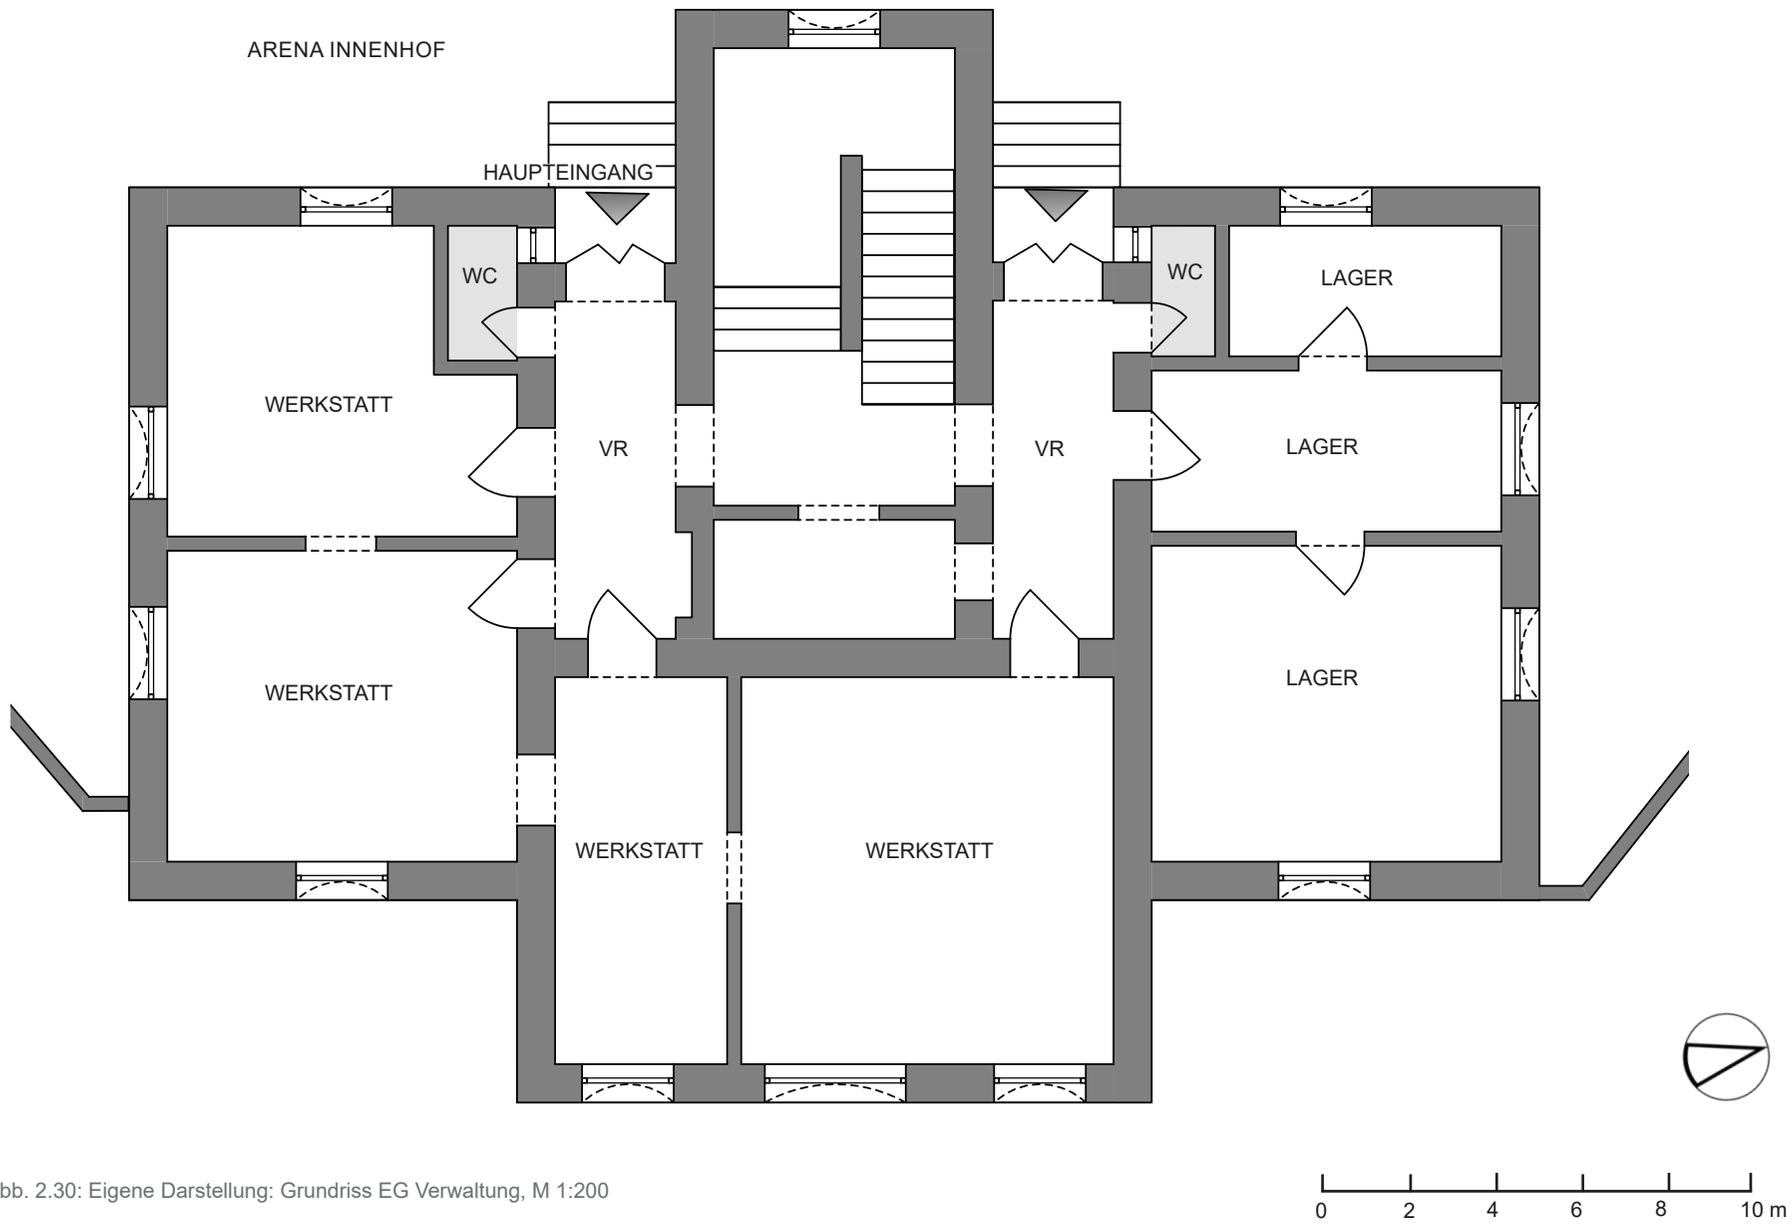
Eigene Darstellung: Grundriss EG Verwaltung, M 1:200
